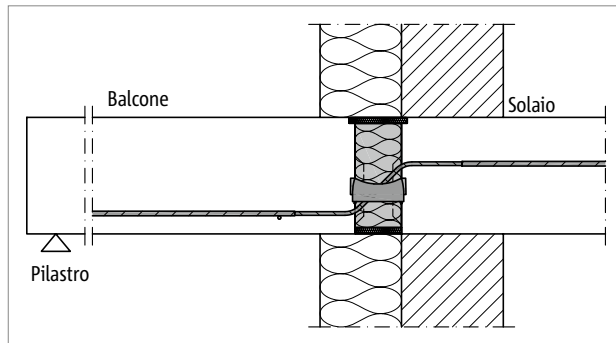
Schöck Isokorb® T tipo QL: raccordo con sistema di isolamento a cappotto
